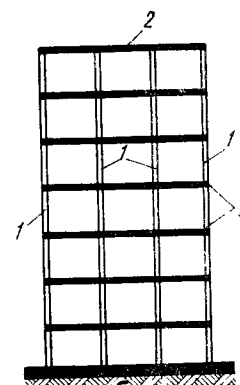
Secțiune prin structură cu stâlpi și dală groasă :
